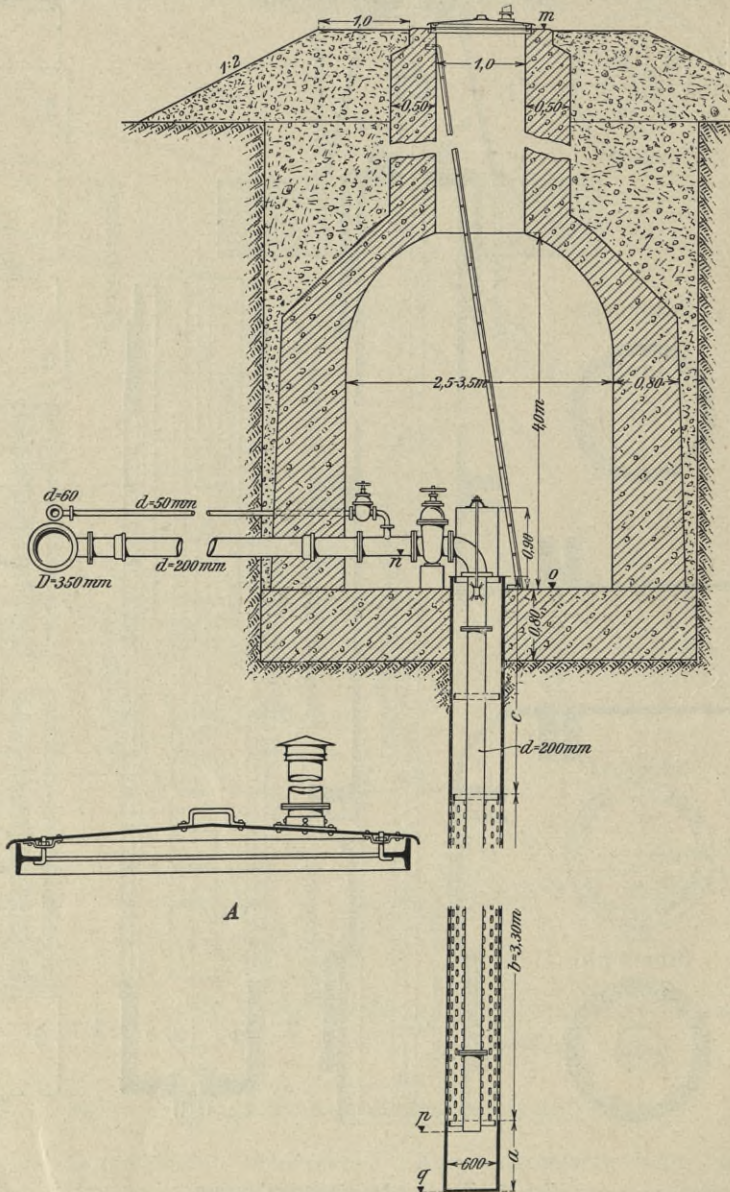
Filterrohrbrunnen mit Schacht. A Detail des eisernen Schachtdeckels.
